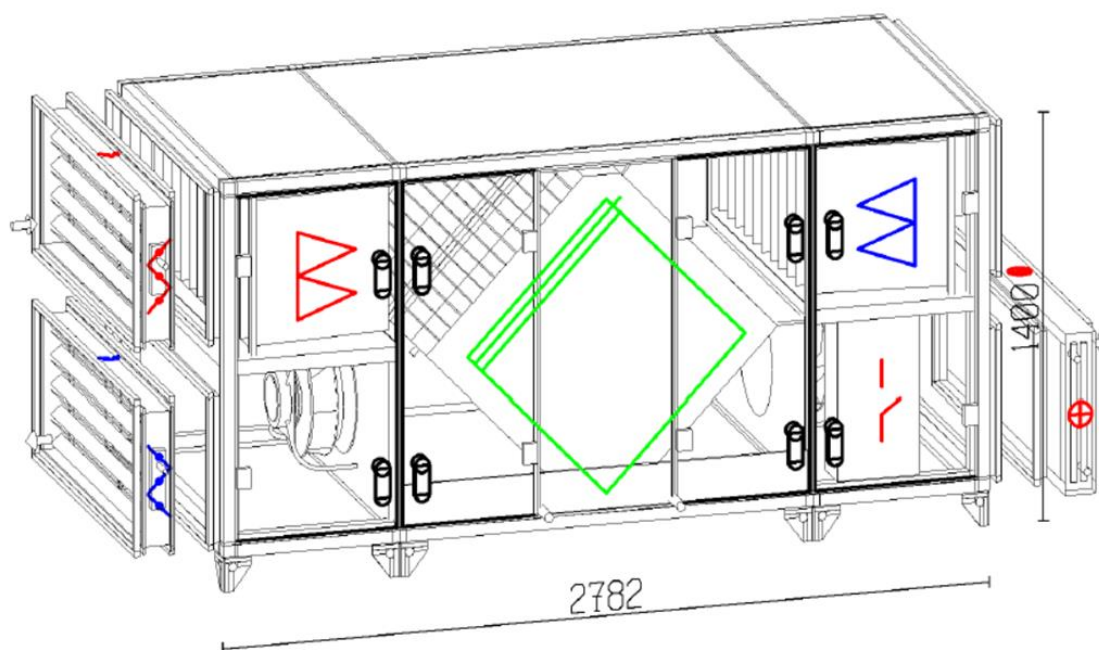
Конструкція та геометричні розміри припливно – витяжної установки Geniox Core 12
